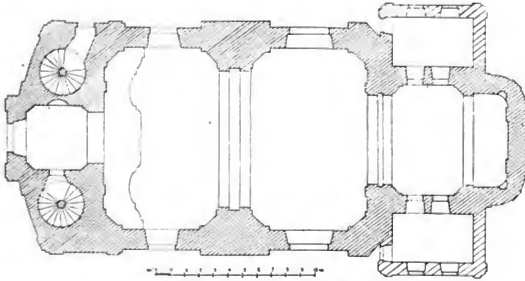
Wysoka Grundriss der Kirche.
